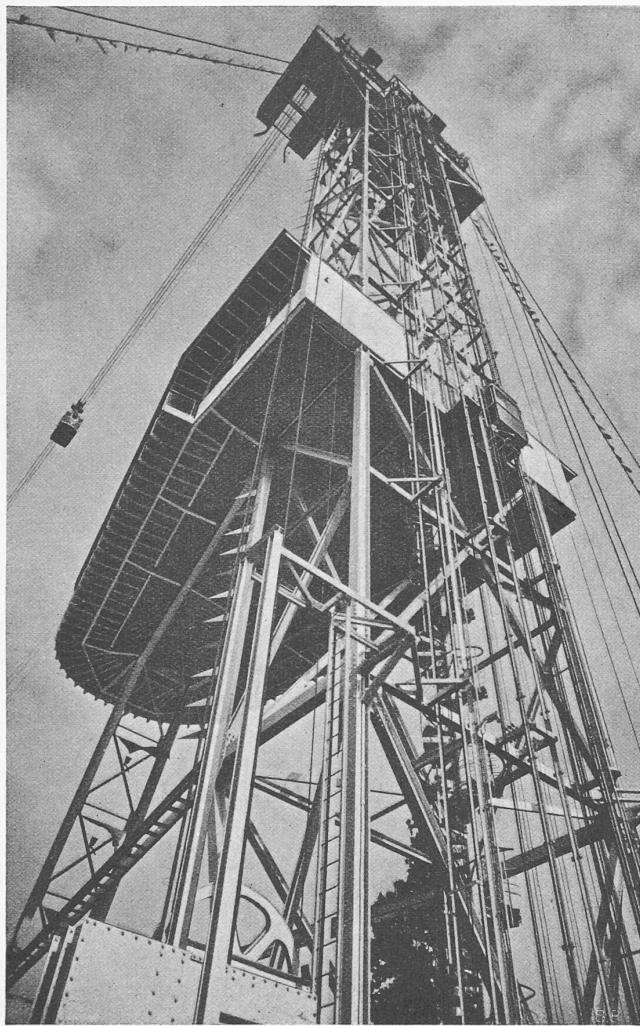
Linksufriger Turm, Rückansicht mit den Aufzugschächten
